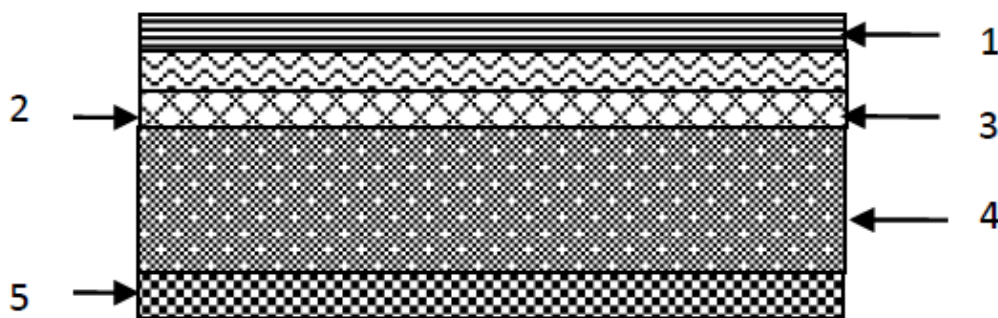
Coupe transversale dans le plancher à dalle pleine.
